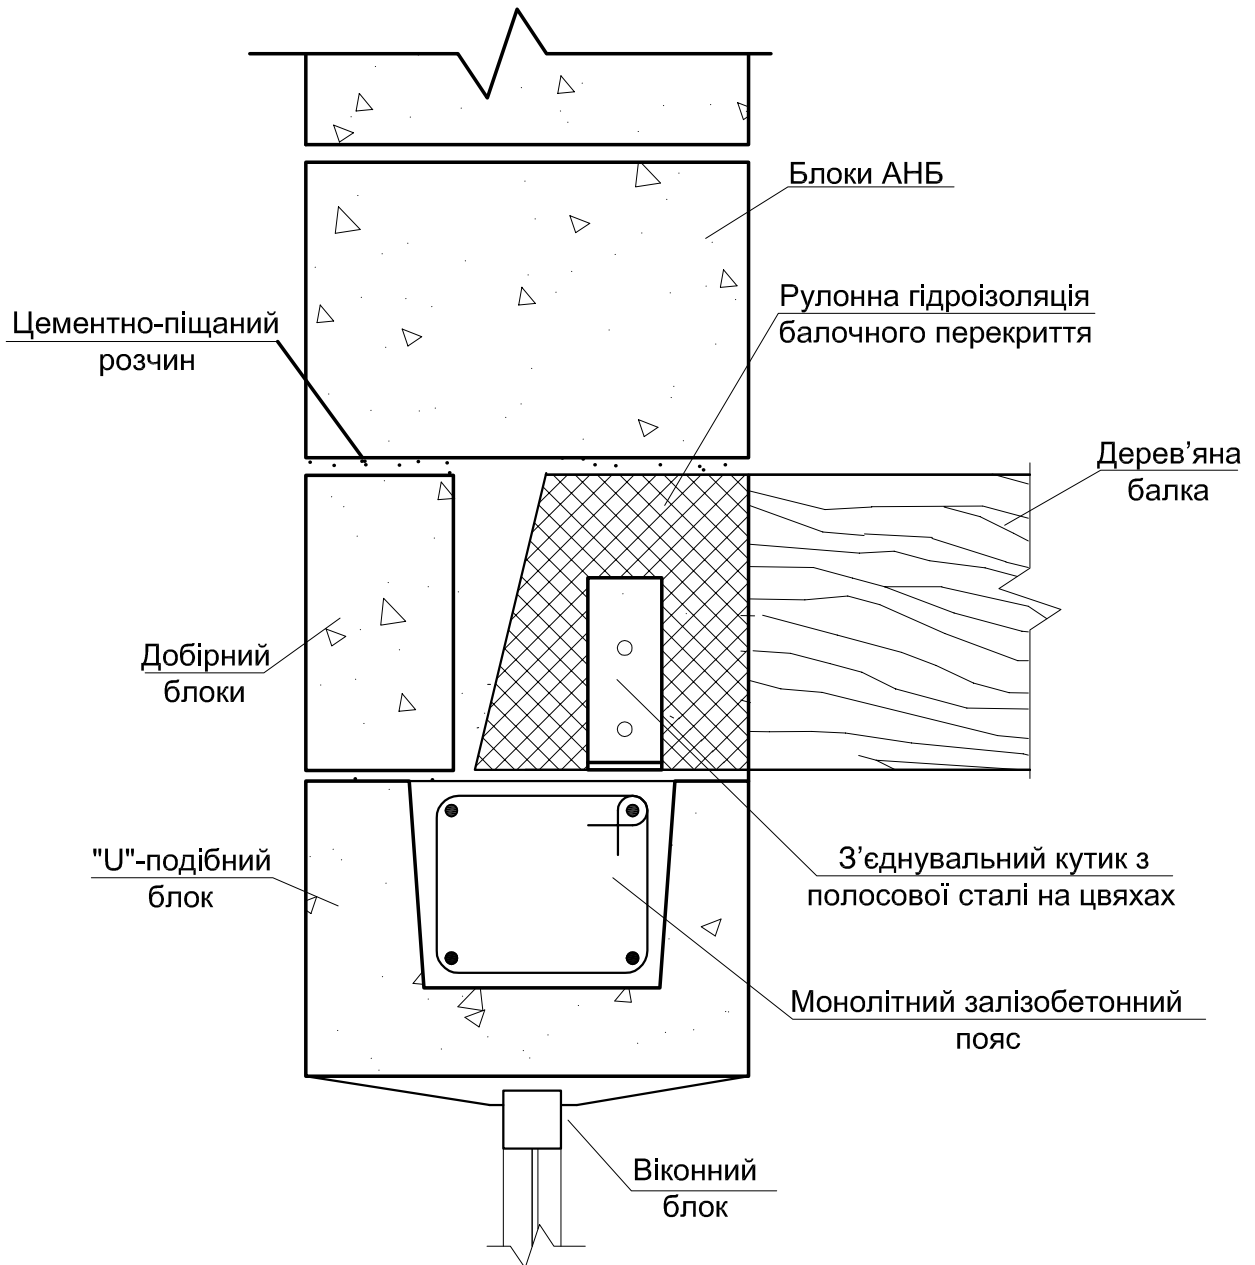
Перемичка з U-блоків з обпиранням перекриття По дерев'яних балках
